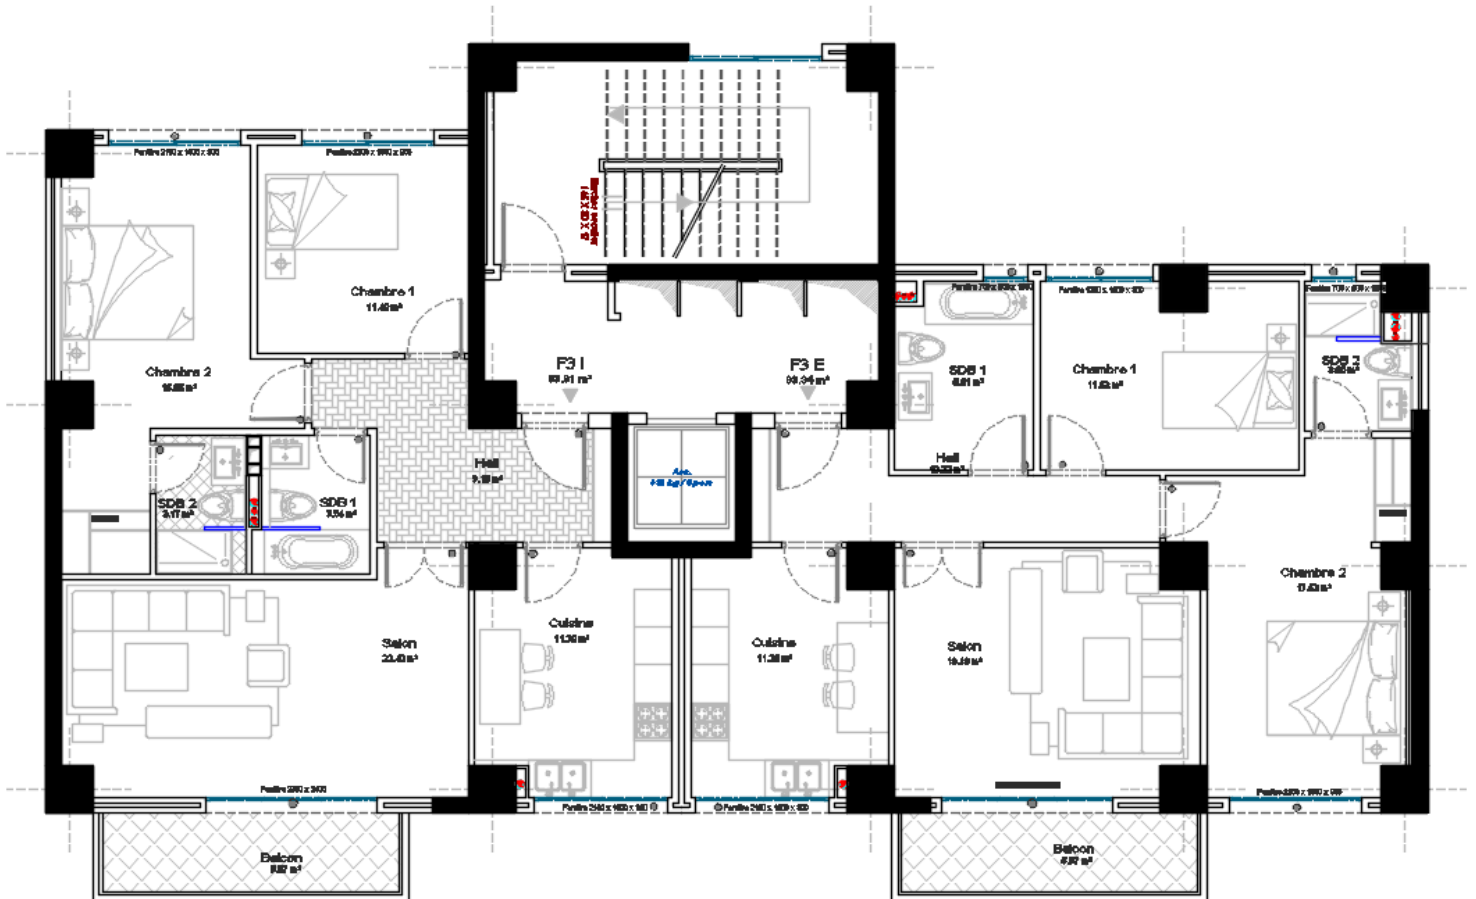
Plan d'architecture d'un étage courant selon le 1<sup>er</sup> système constructif
